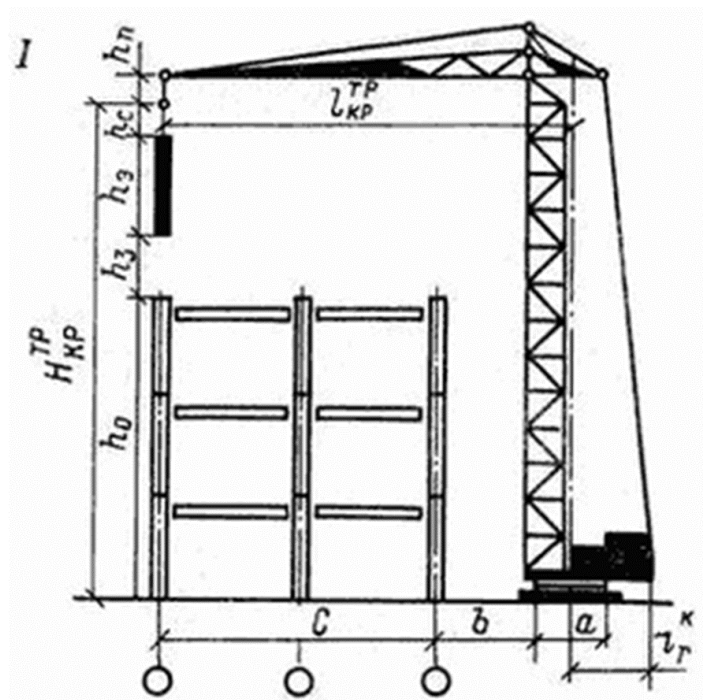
Схема прв'язки баштового крану до будівлі
